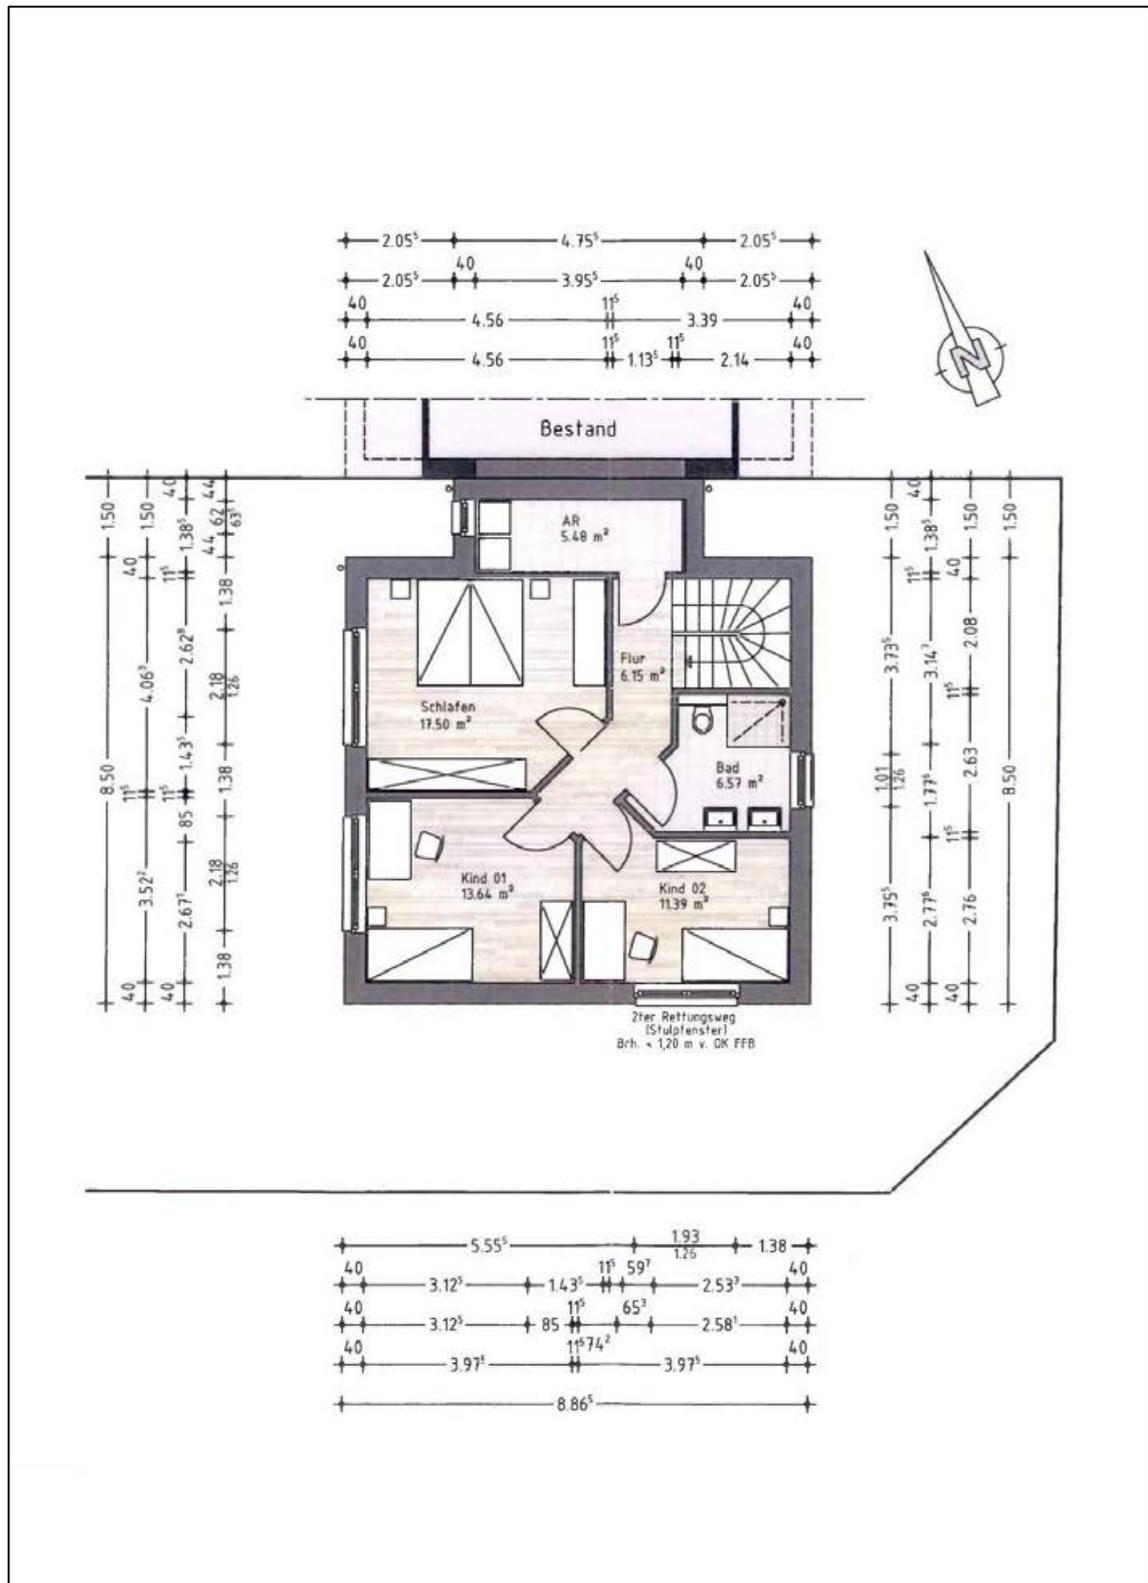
1.Obergeschoss Grundriss vom Einfamilienhaus
